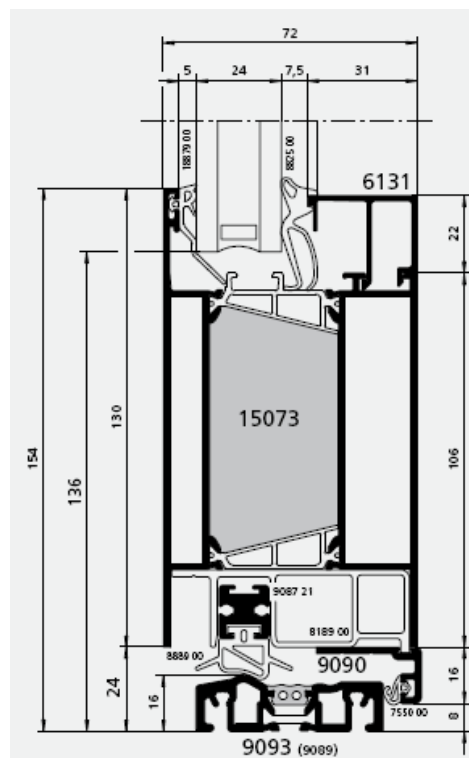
DETAIL PODKLADOVÝ PROFIL - VÝŠKA = 32 mm
